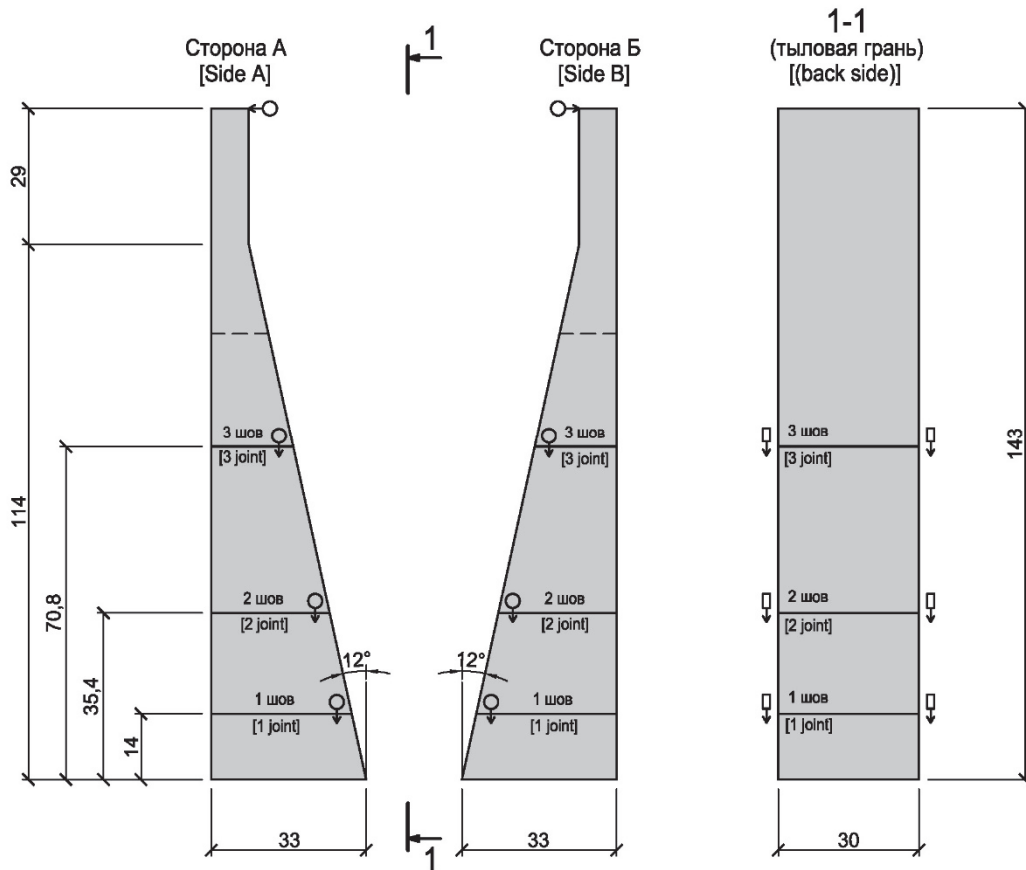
Схема установки контрольно-измерительной аппаратуры на железобетонной модели подпорной стены
